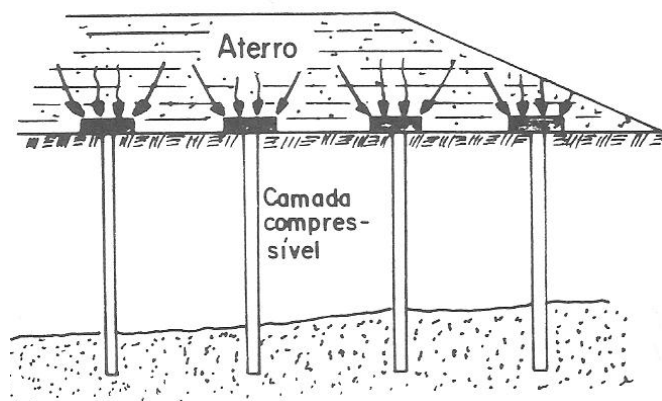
Utilização de estacas e placas de concreto (Alonso 1989).
